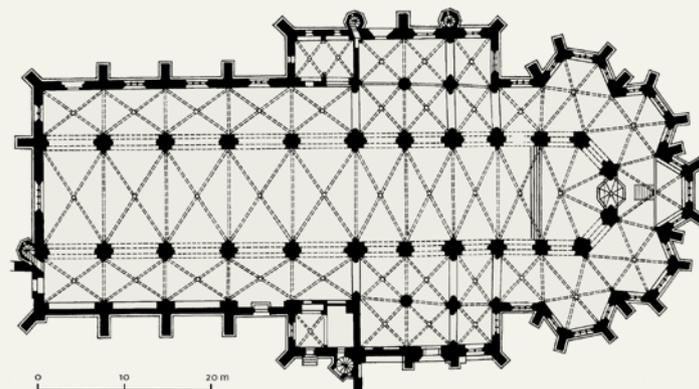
Ehem. Zisterzienserabteikirche Doberan, Grundriss
